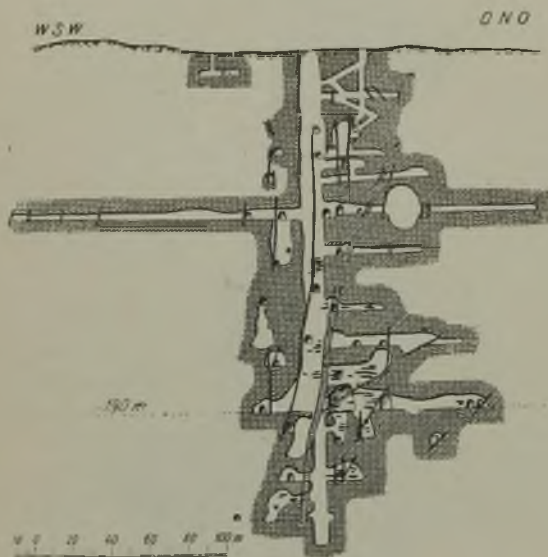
Querprofil nach der Linie A - B des Grundrisses.
